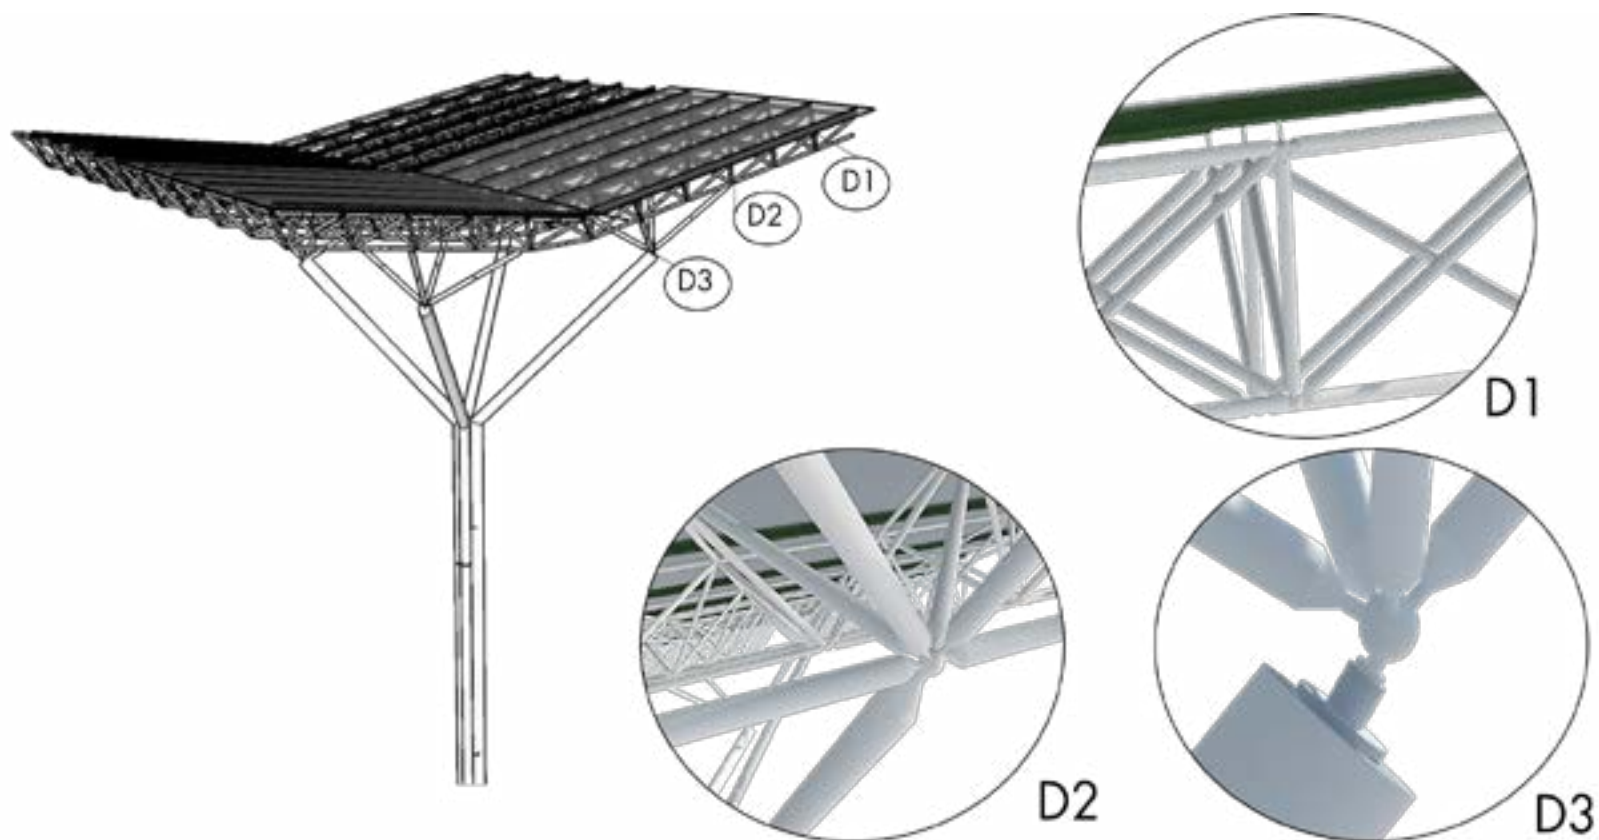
Sánchez, R. (2019). Detalle de unión de estructura de la columna con la cubierta.
